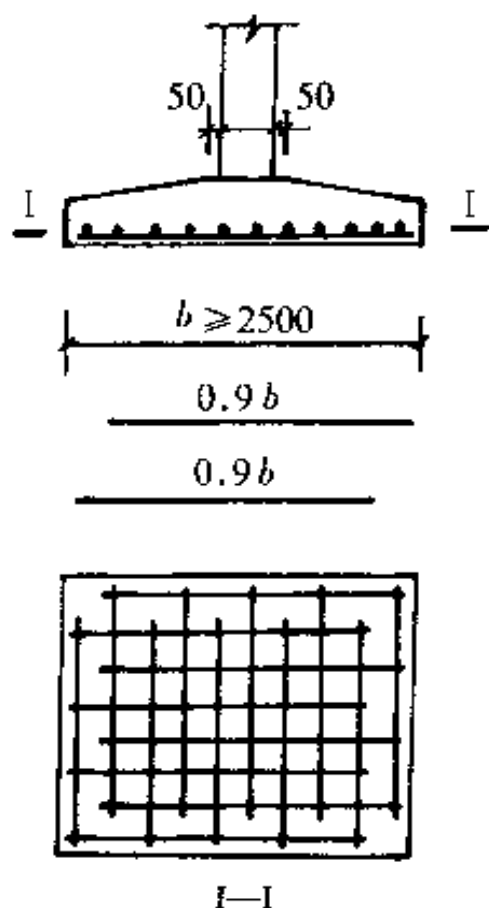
扩展基础底板受力钢筋交叉布置示意图
